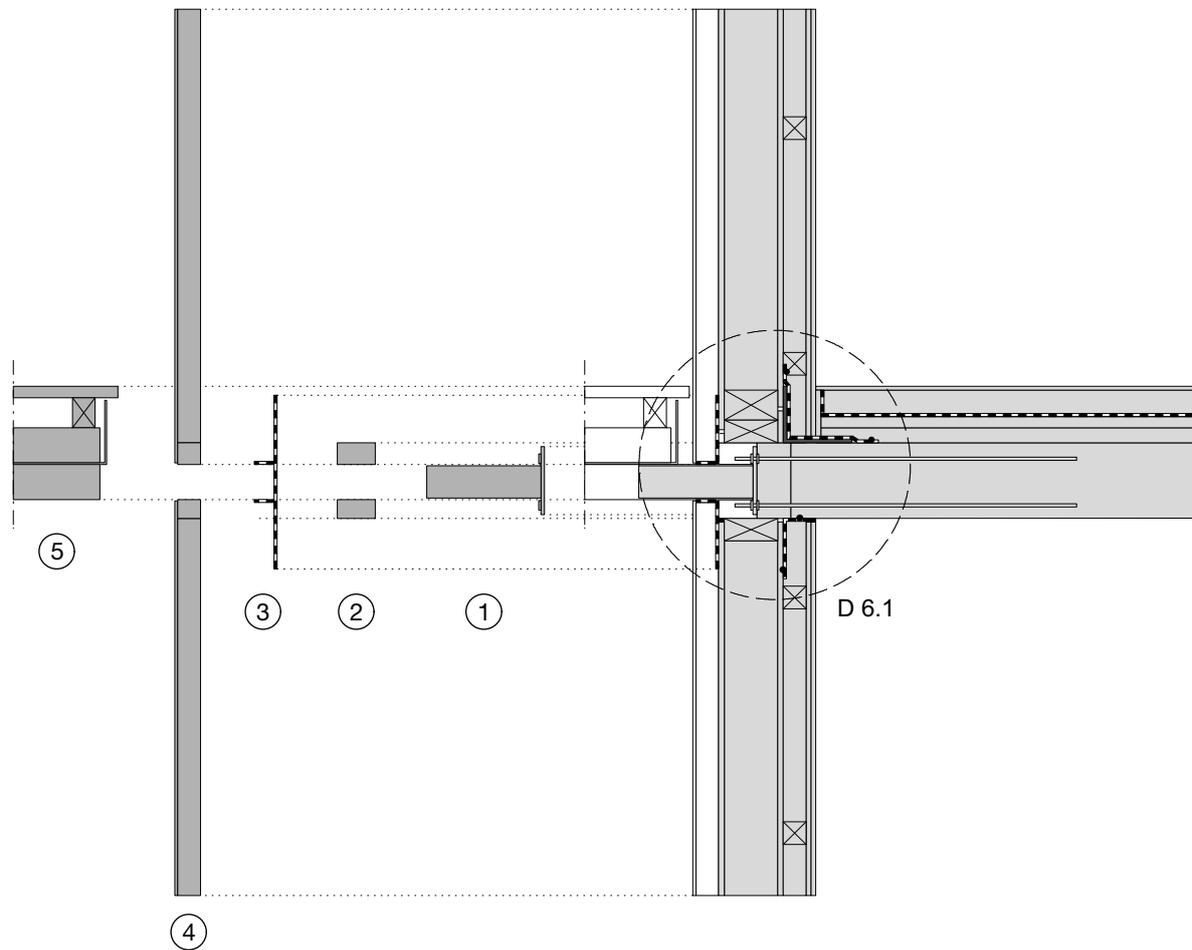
Montagereihenfolge - Anschluss Geschossdecke - Außenwand, vorgestellt - vorgestellter Balkon
